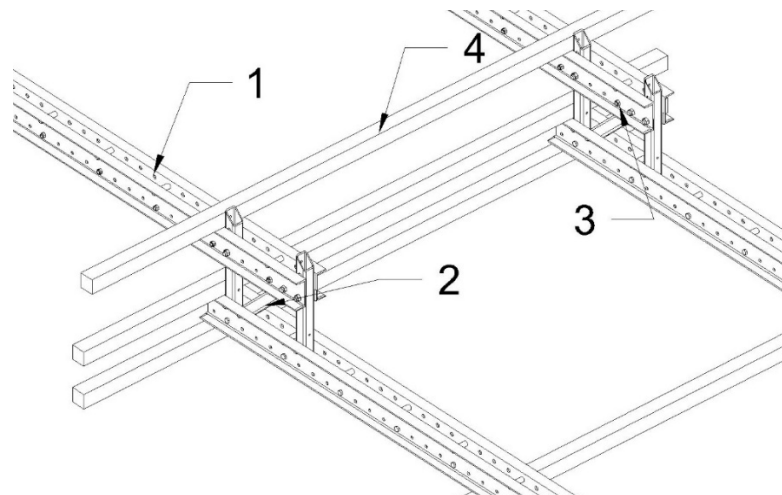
Схема збирання z-подібної панелі. Встановлення верхньої направляючої штанги: 1 – штанга переставна ; 2 – діагональна розпірка 69 RCS; 3 – болт, гайка
